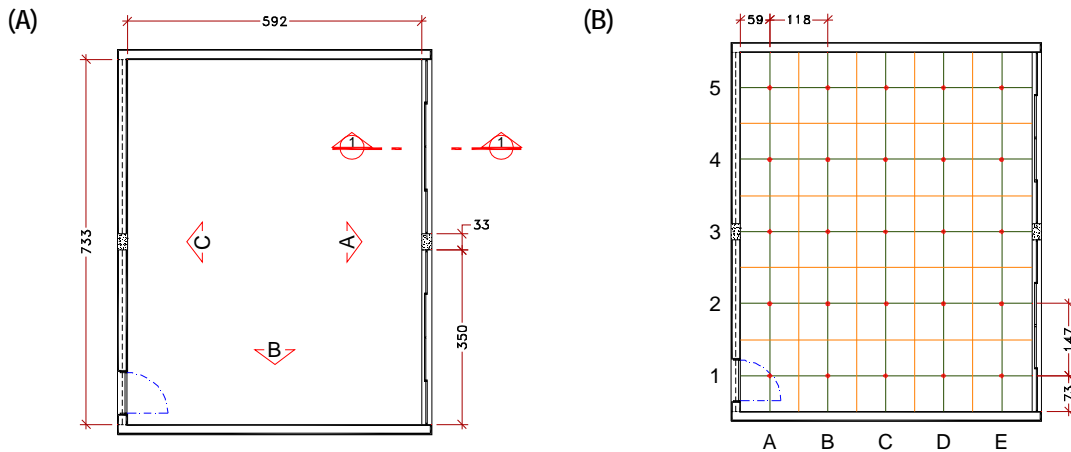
Sala 2: (A) Planta Baixa; (B) Malha de pontos
